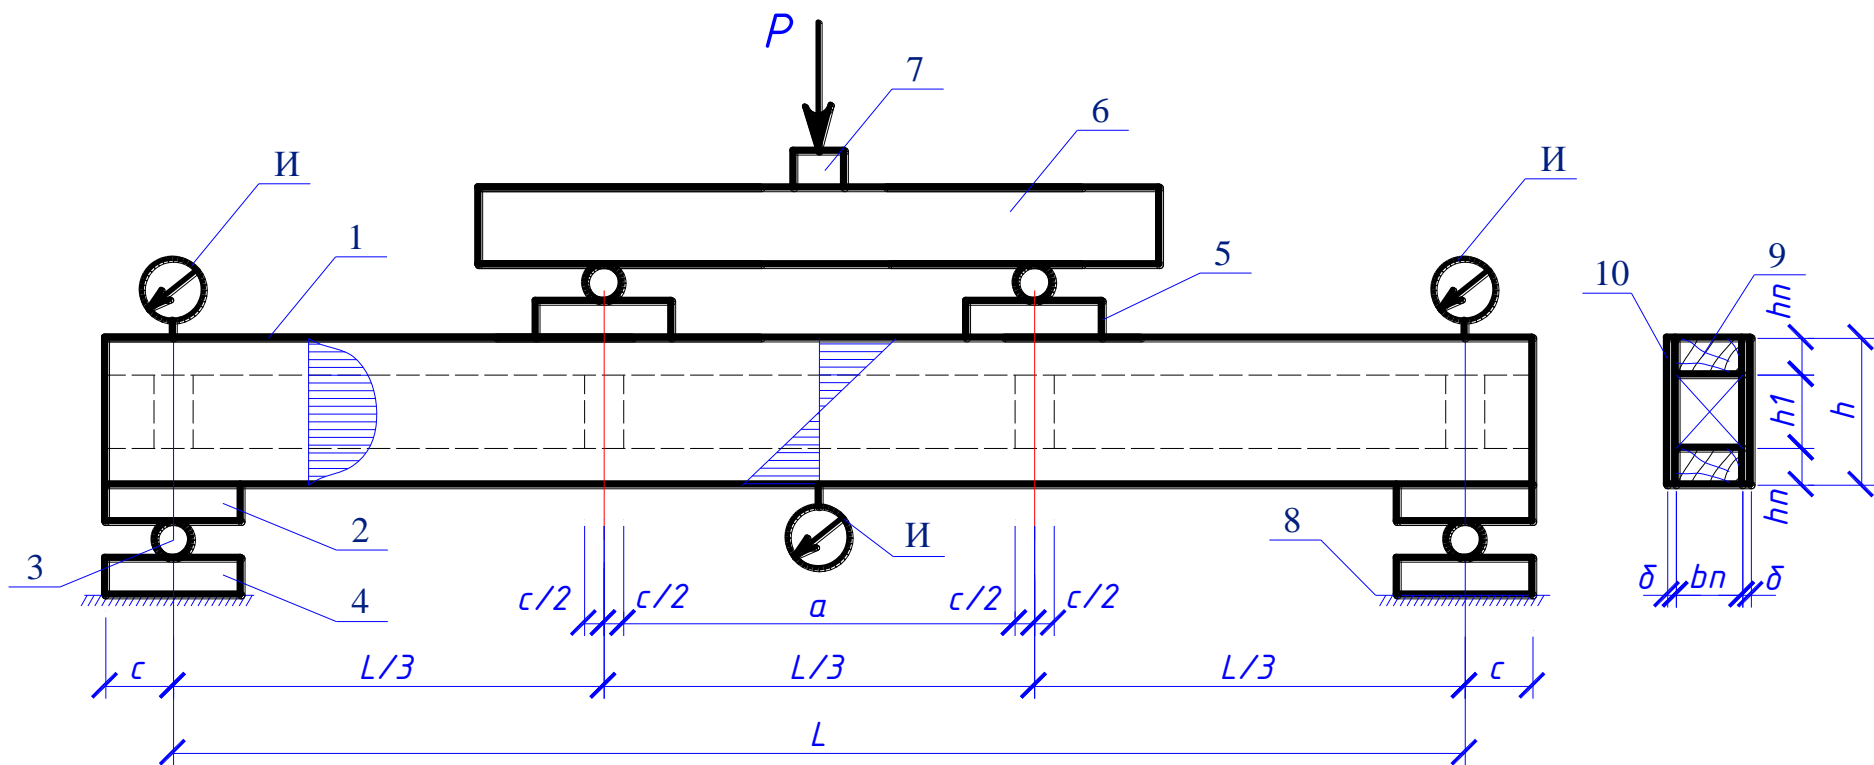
Конструкция и схема испытания на статический изгиб клееной фанерной балки:
